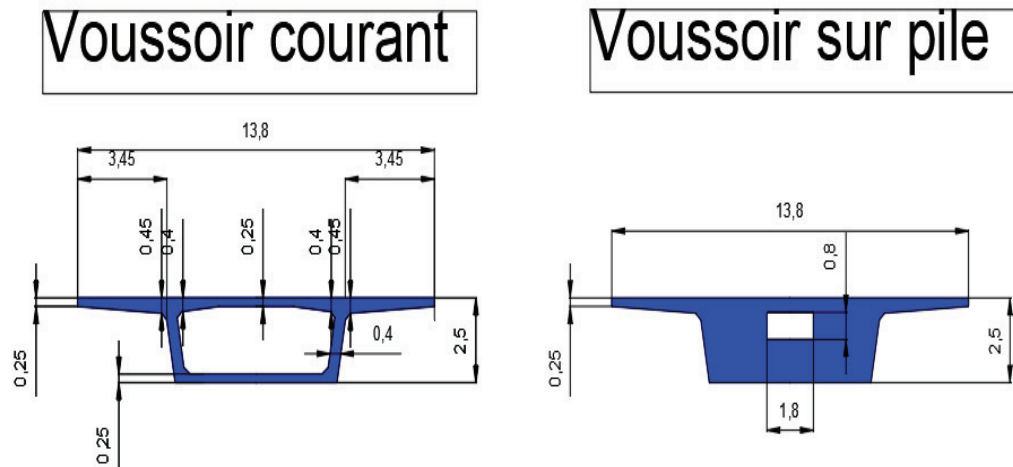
Les dimensions des voussoirs (VSP et VC)
